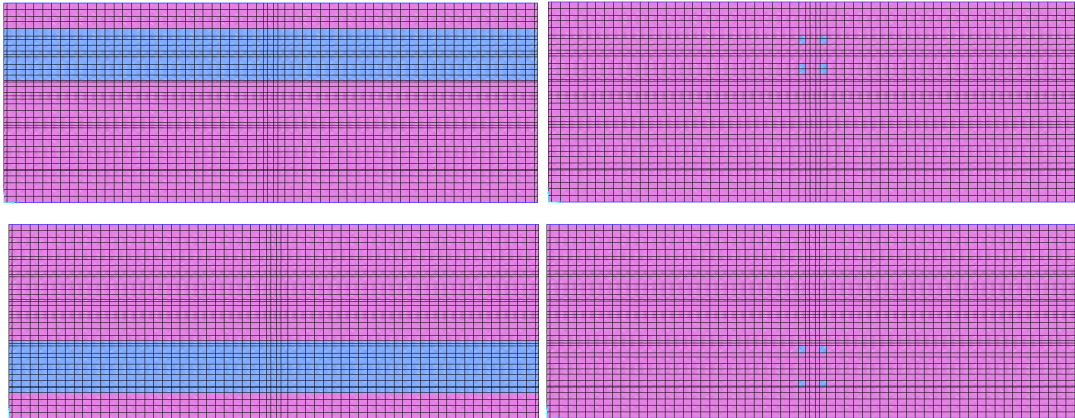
Posizione delle corsie e dei carichi tandem nella prima disposizione SLU1.2
